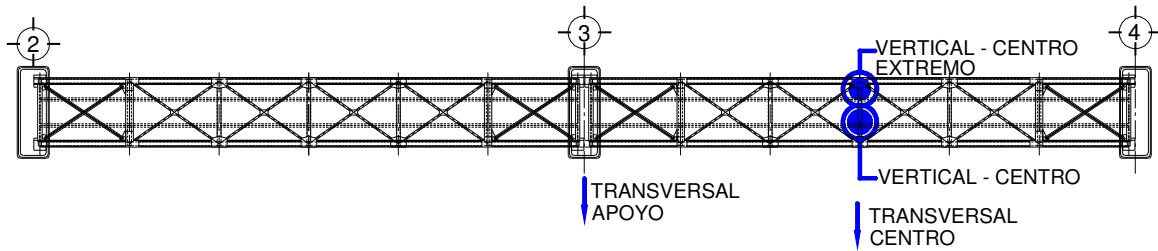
Posición de sensores en planta sobre el puente La Lana. Claro 3-4
